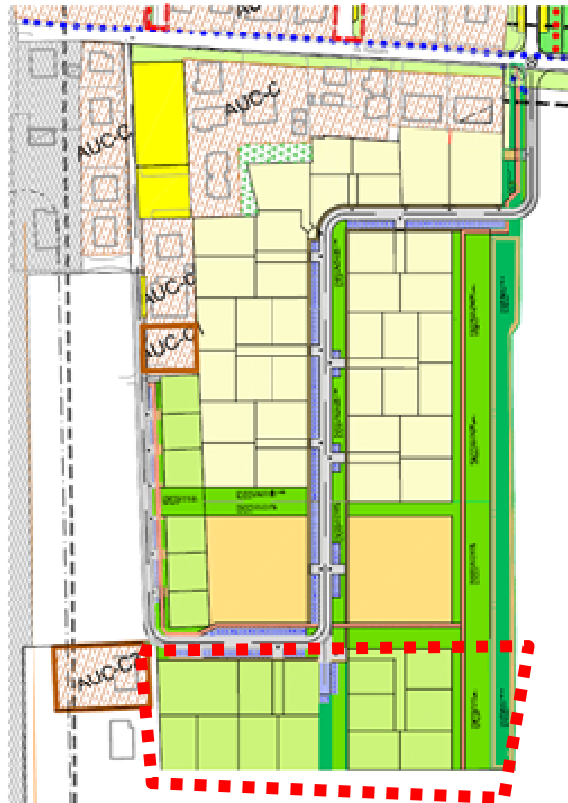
Planimetria progetto Sub-Ambito 5.2
